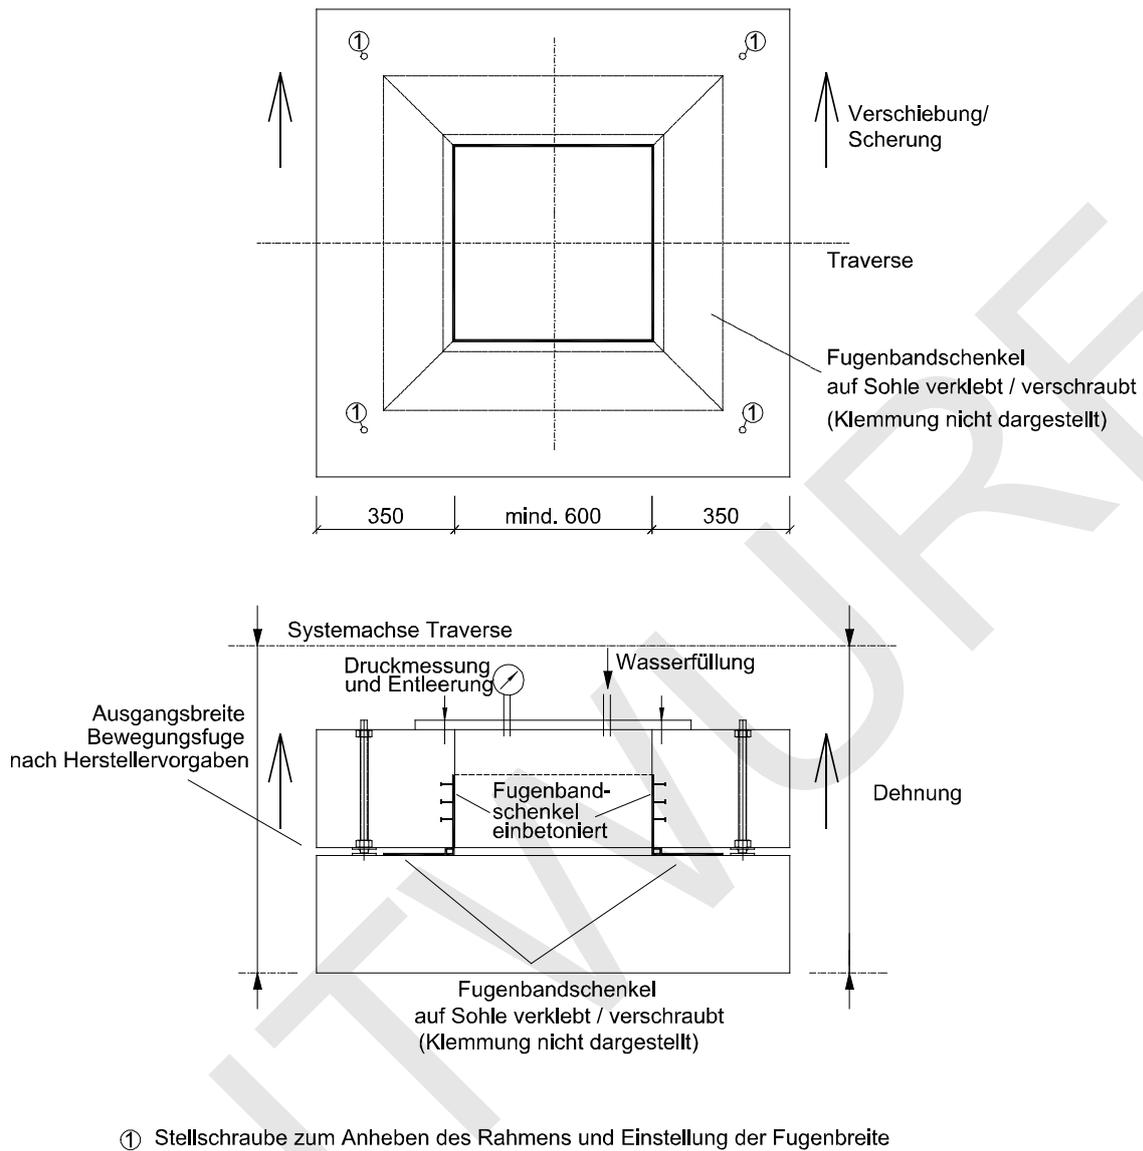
einschenklig einbetoniertes sowie einschenklig adhäsiv aufgeklebtes Fugenband, Prinzipskizze (die aufgeführten Abmessungen stellen Mindestabmessungen dar [Maße in cm])
